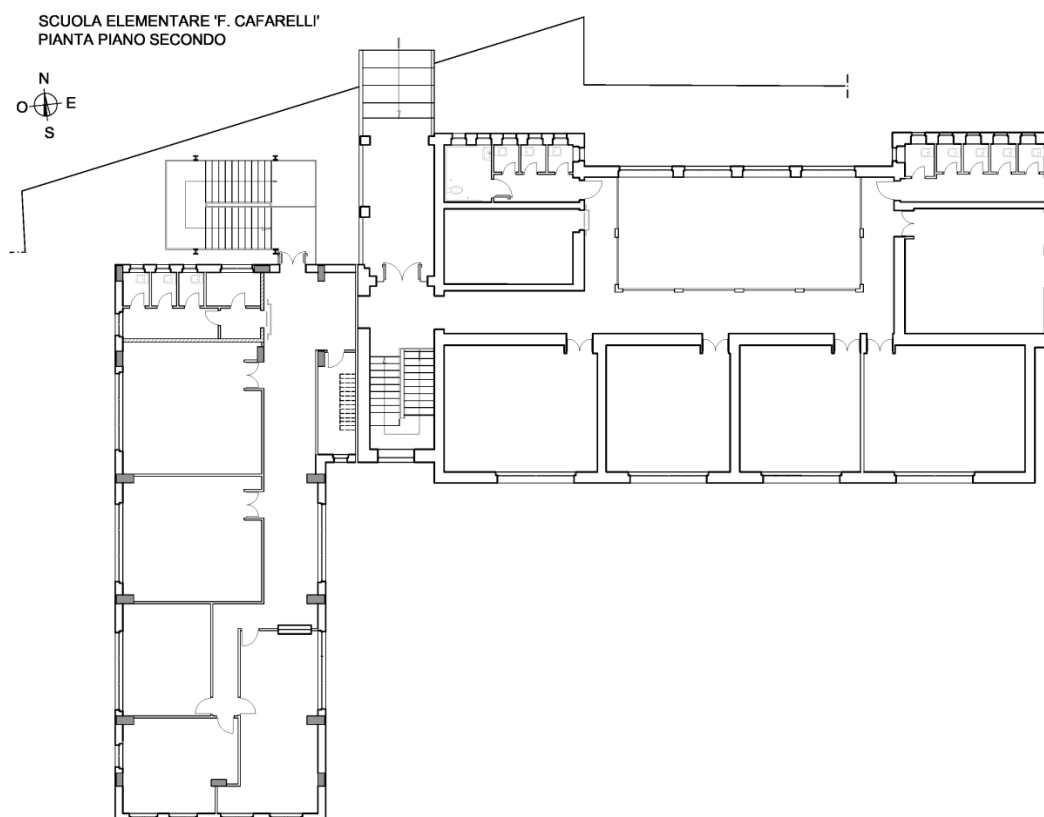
Complesso scolastico F. Cafarelli: pianta piano secondo
